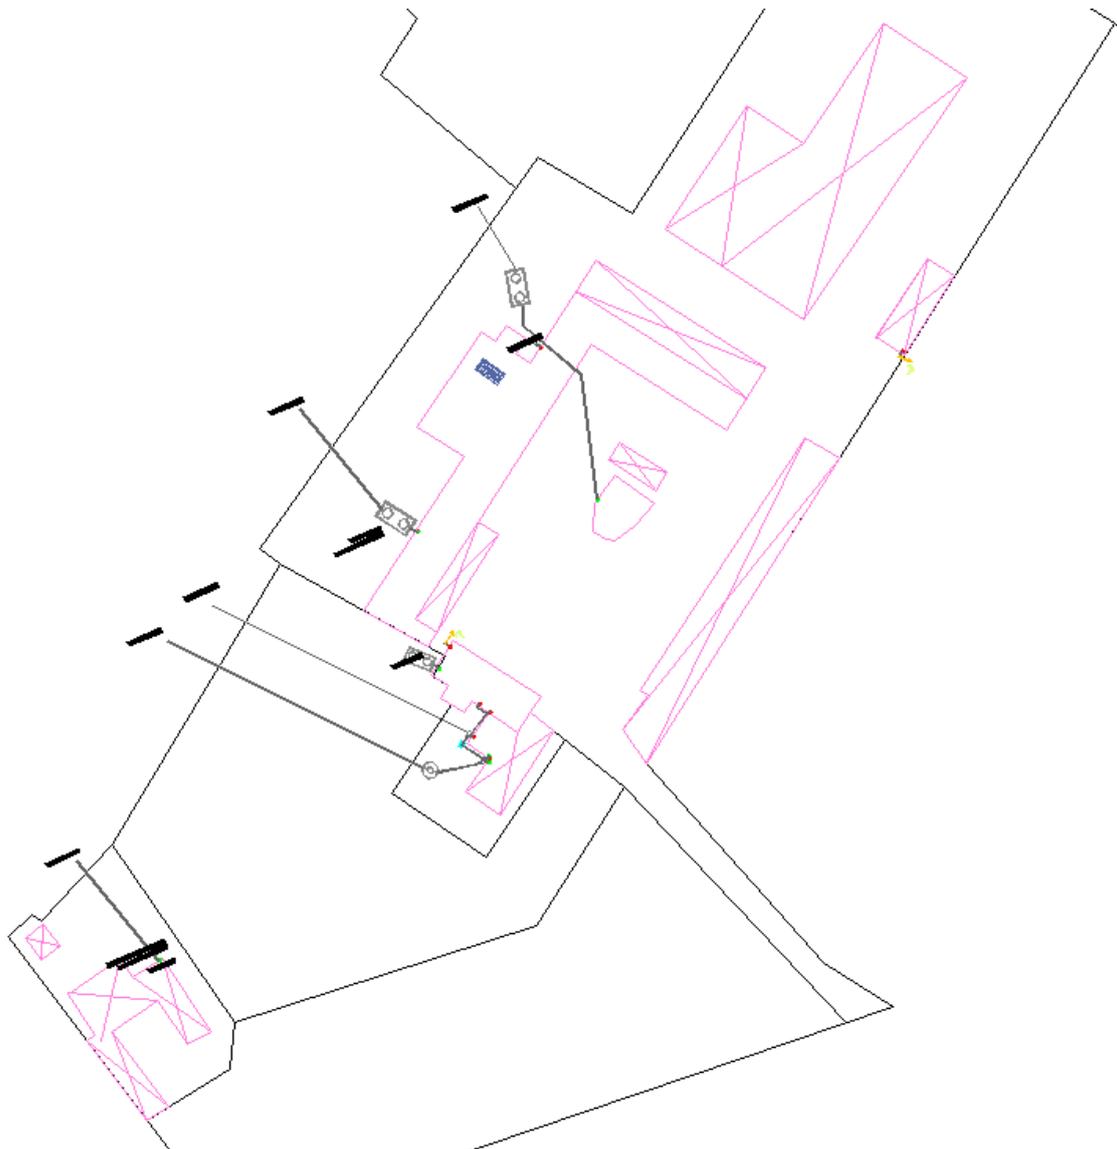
Plan diagnostique des installations d'assainissement non collectif
